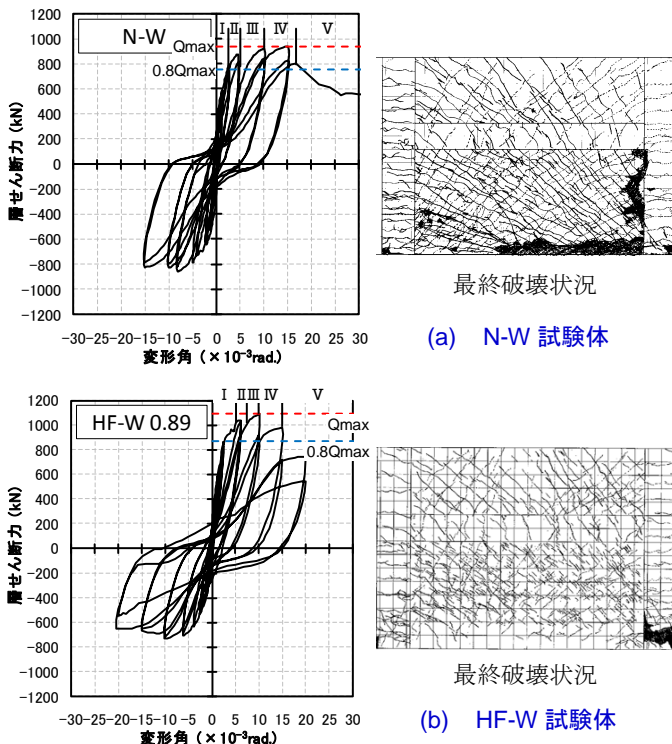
耐震壁試験体の荷重-変形角関係とひび割れ図
